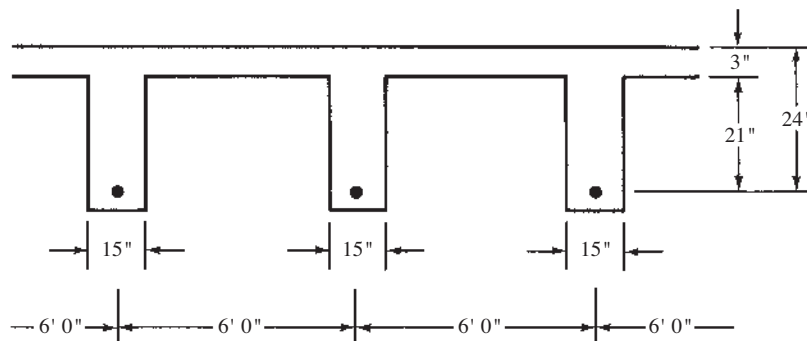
Sección transversal de un sistema de piso con vigas T del Ejemplo 5.5.
